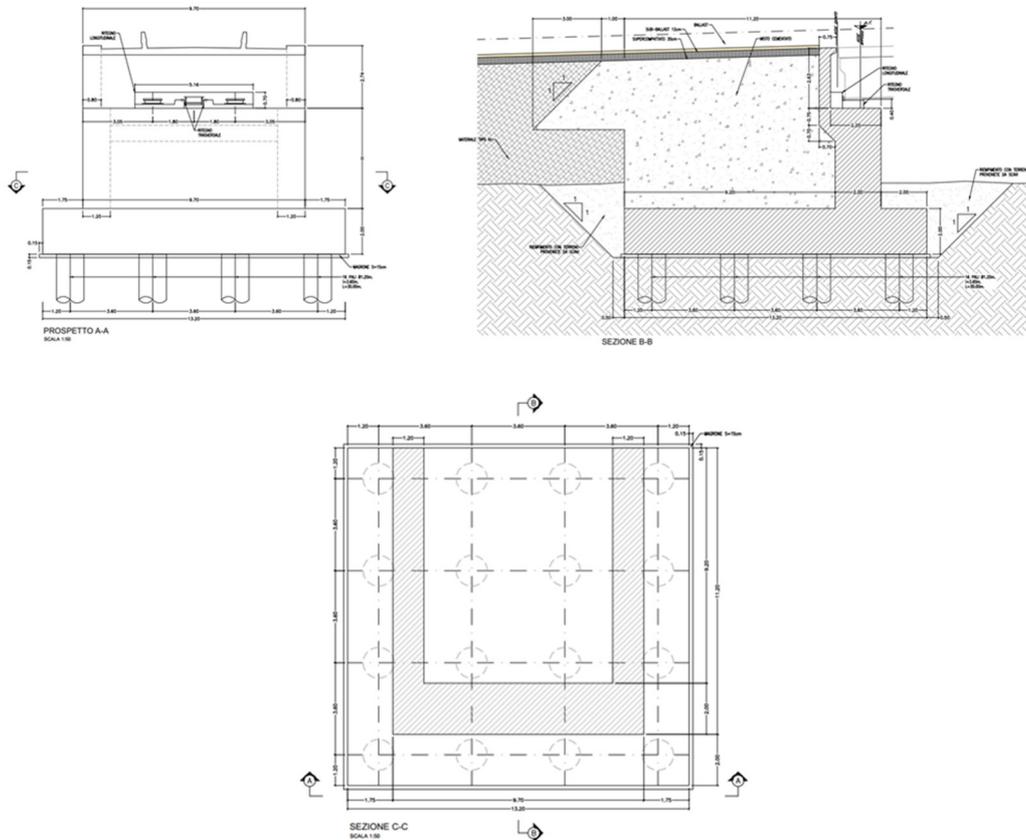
Prospetto e sezioni spalle [m]
